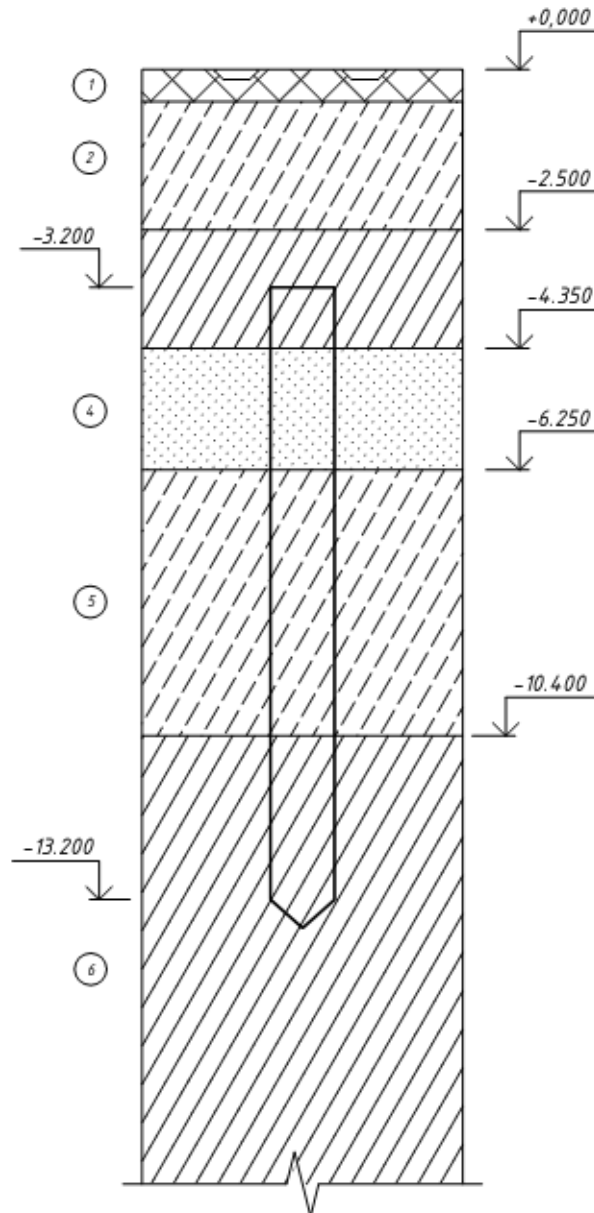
Схема расположения забивной сваи в грунте
